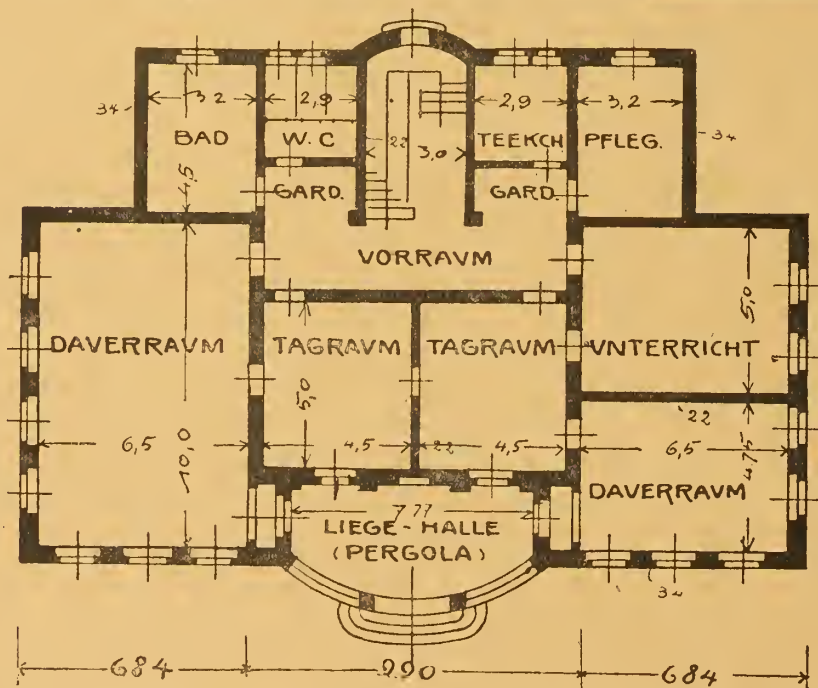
Erdgeschoß. Irrenanstalt Friedrichsberg. Haus für Jugendliche.
